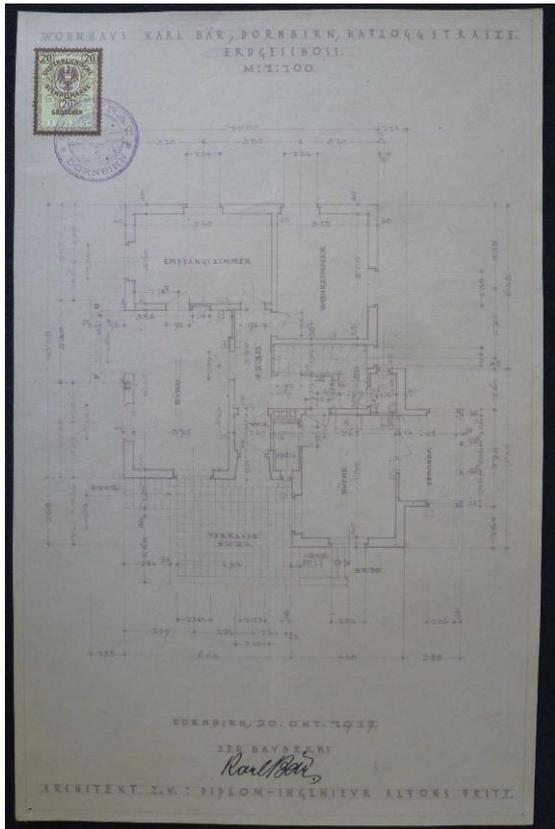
Alfons Fritz, Haus Bär, Dornbirn, Grundriss Erdgeschoss 1:100, 20.10.1927
